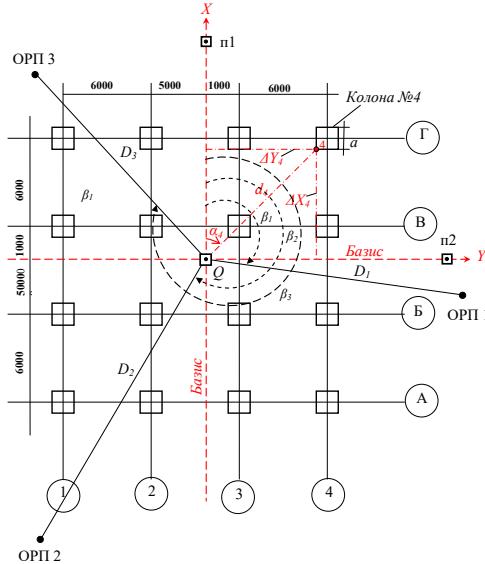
До розпланування будівельних конструкцій в системі координат будівлі
